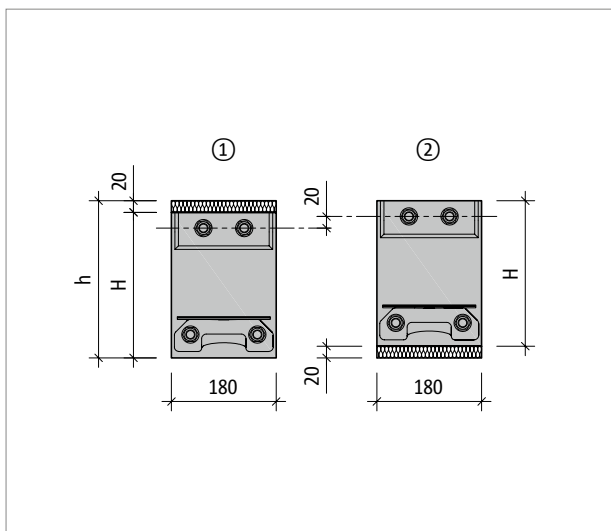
Schöck Isokorb® T type SK : disposition avec décalage en hauteur
